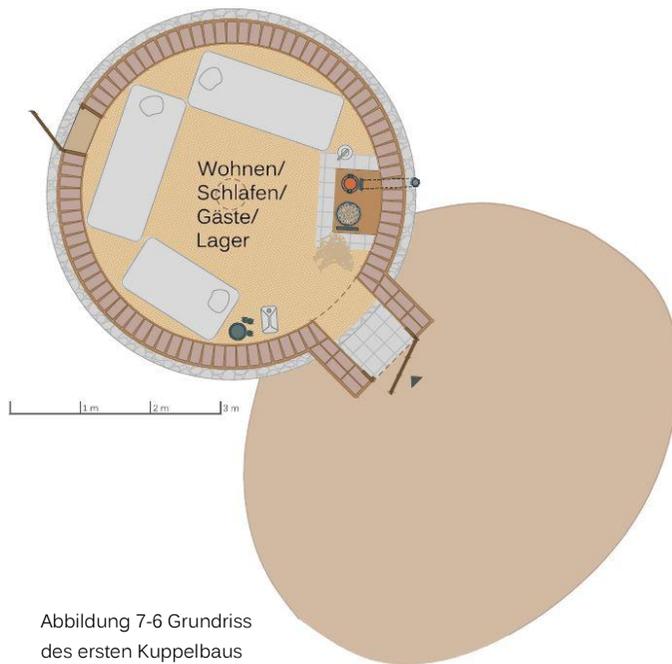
Grundriss des ersten Kuppelbaus
